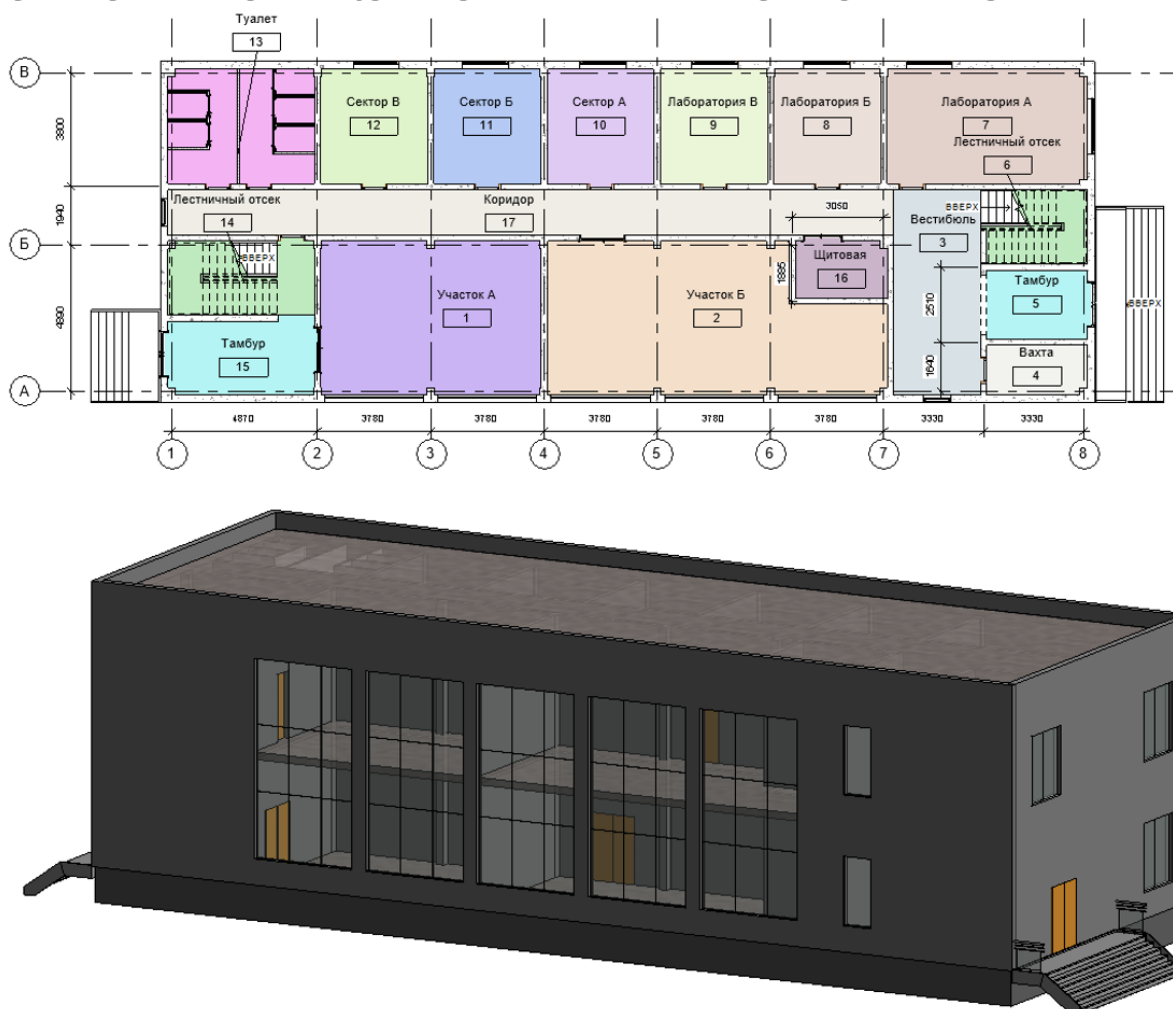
План 1-го этажа и 3D вид производственного здания
